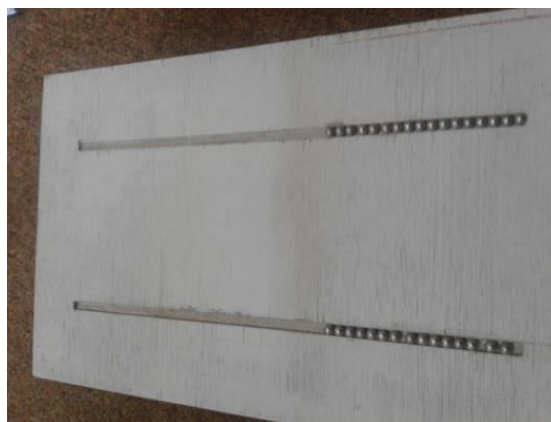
Pemasangan Baut Dengan Lem 2 Ton
